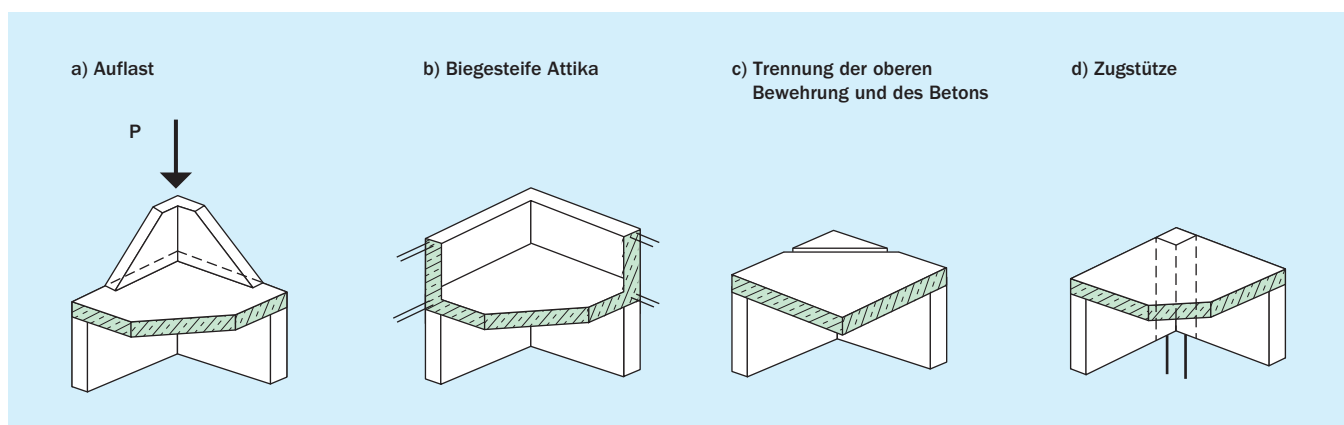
Maßnahmen zum Verhindern von „Schüsseln“ von Betondecken im Eckbereich
